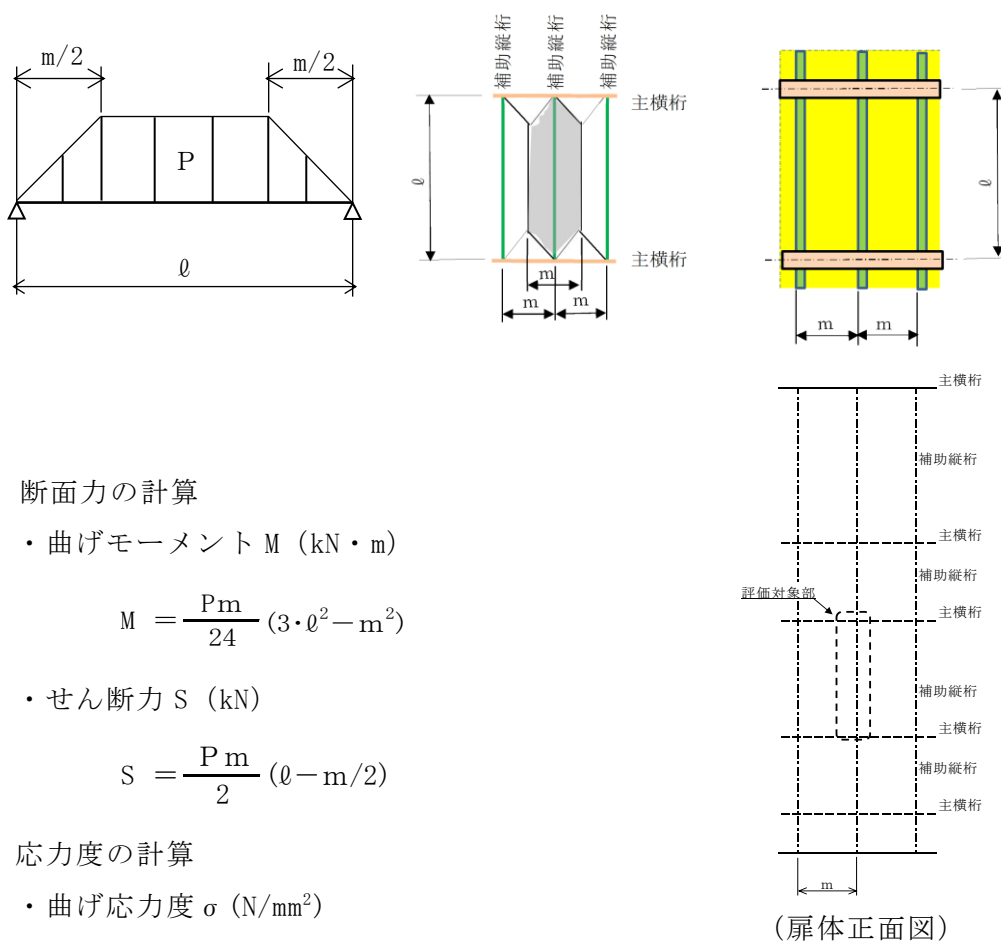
スキンプレートの構造図及び応力算定式
